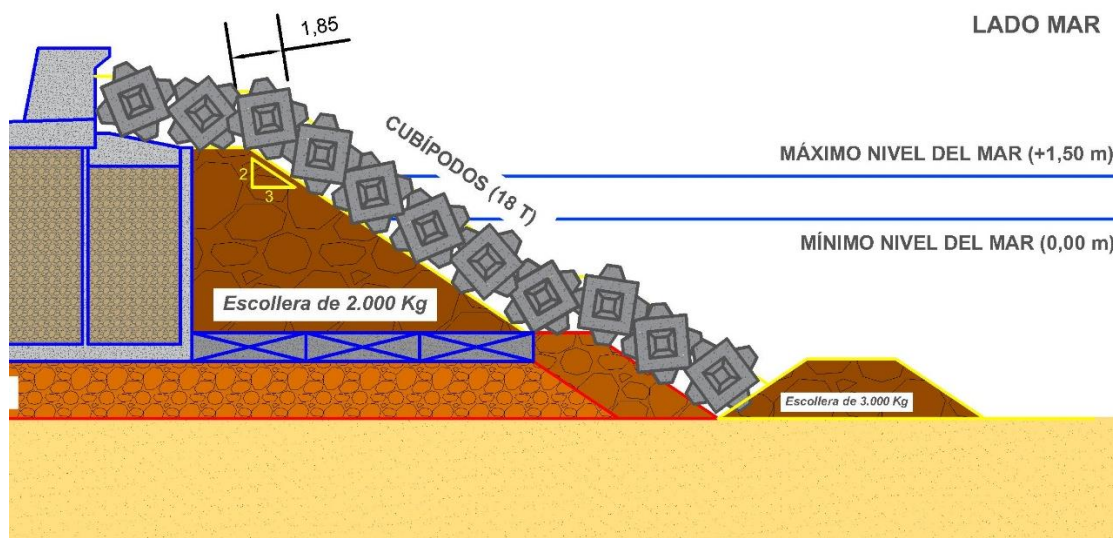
Sección tipo de la alternativa E. Cotas en metros.
